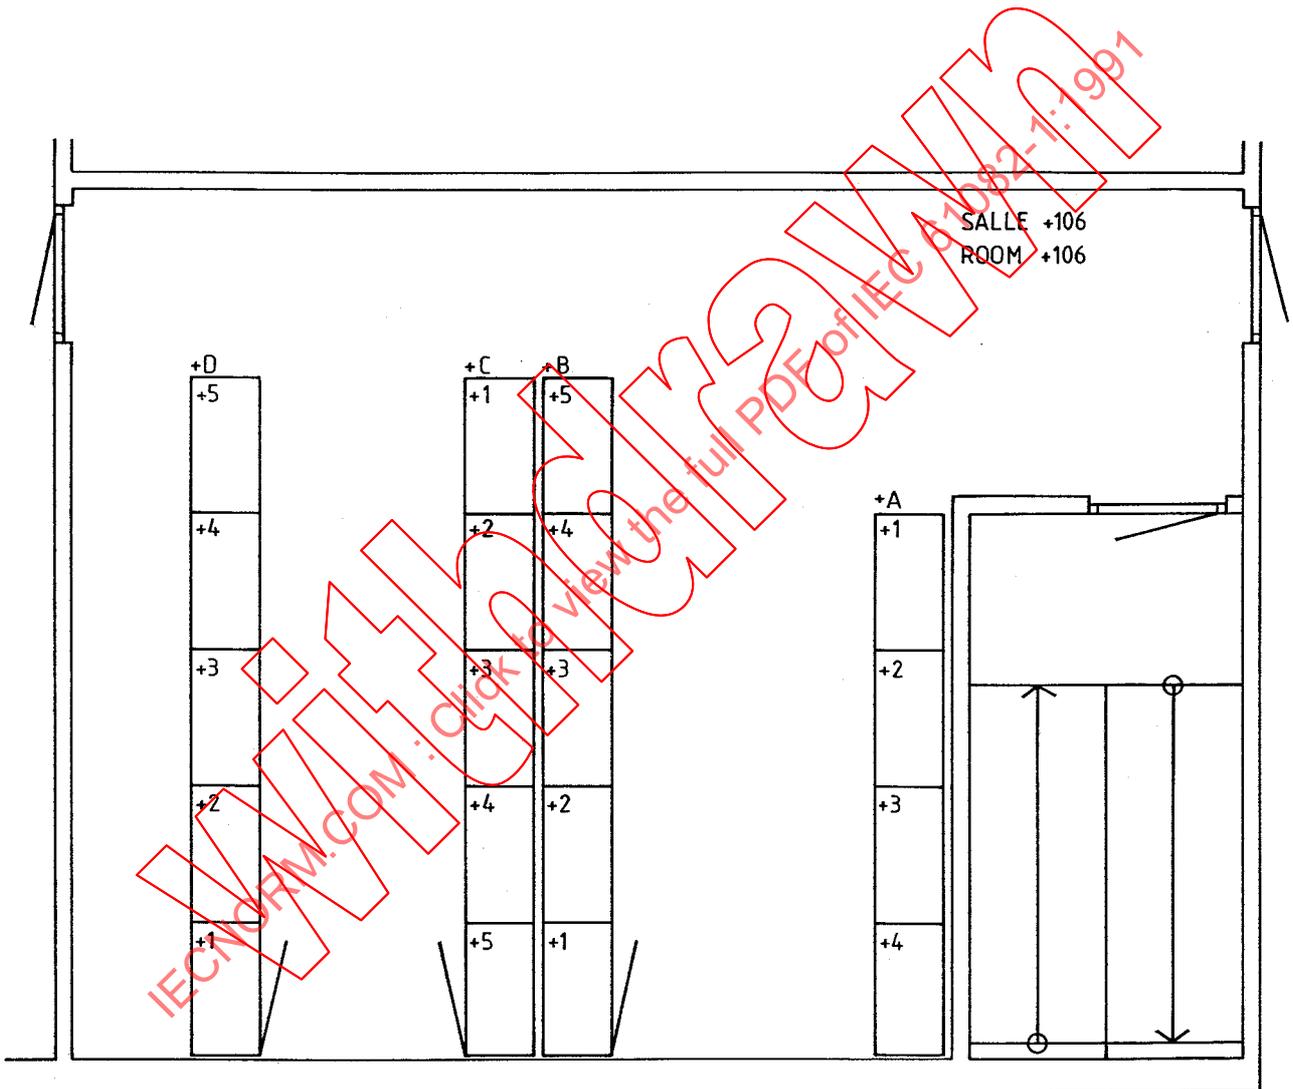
Exemple de plan d'installation; salle de commutation avec ensembles d'appareillage.
